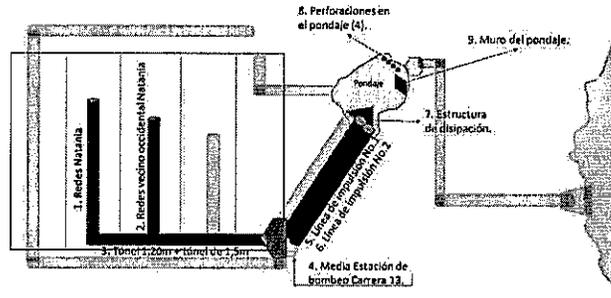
Esquema del componente alcantarillado pluvial SAI ETAPA 1.
